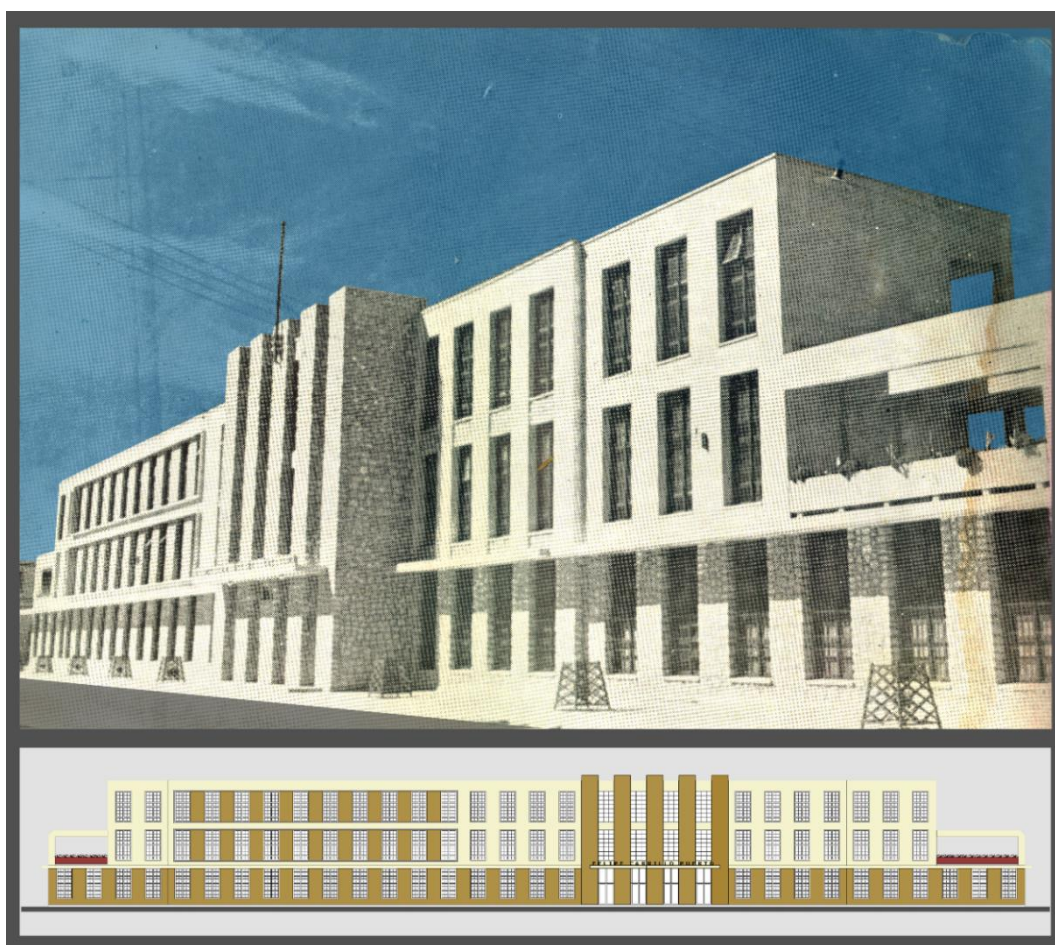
Fotografía de la fachada sobre la calle 54 y Reconstrucción virtual de la misma en plano, el color café representa la piedra aparente. Imagen mejorada con color y de la fachada elaborados por el autor.
